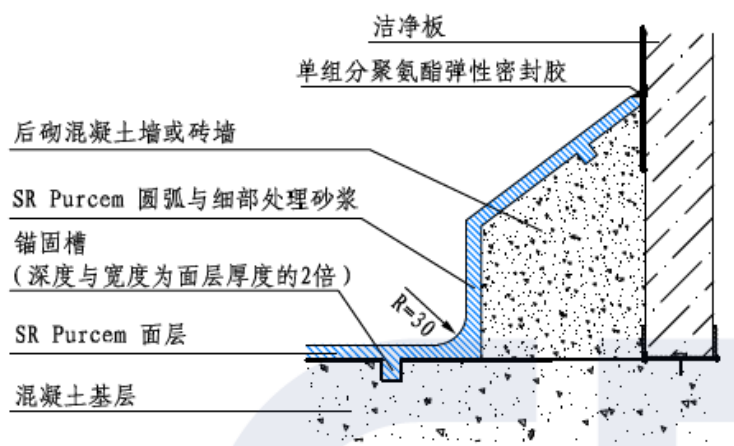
圆弧踢脚施工在混凝土护墙上的做法示意图
